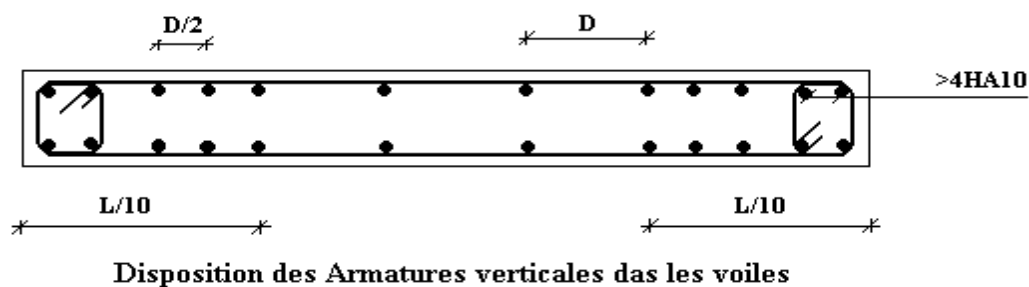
Disposition des Armatures verticales dans les voiles.
